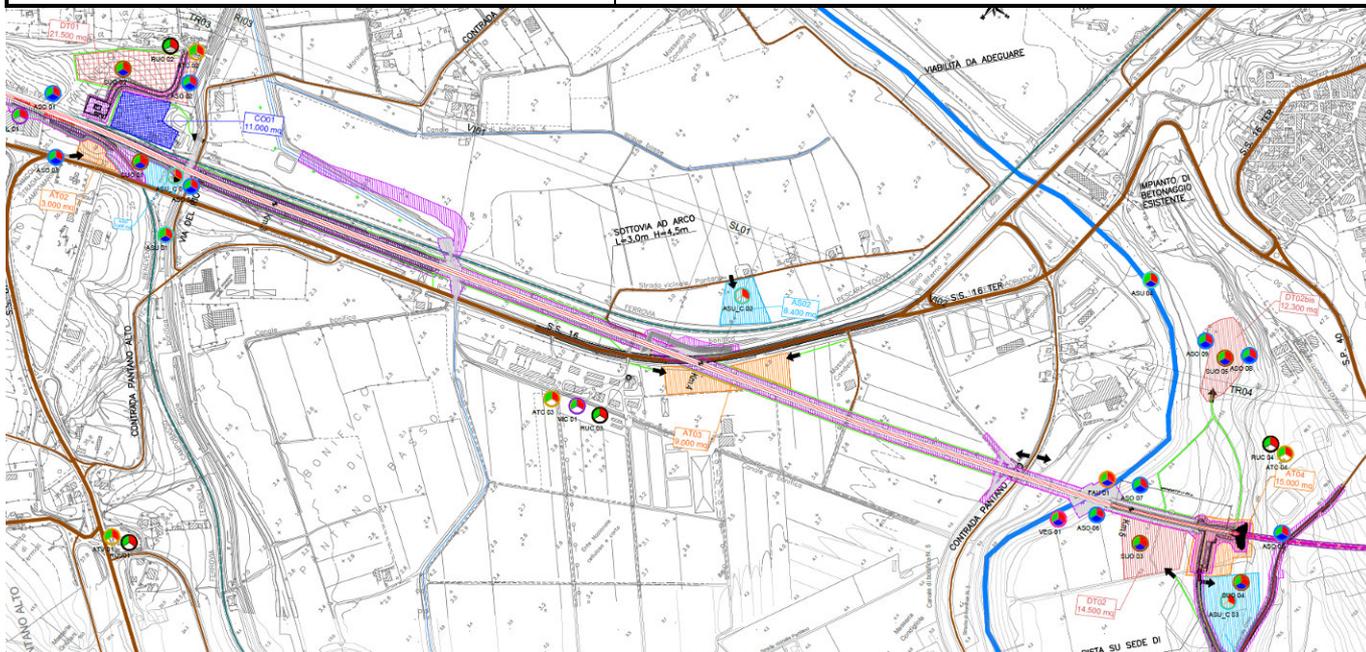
Stralcio Planimetria localizzazione punti di monitoraggio tav 2/9
